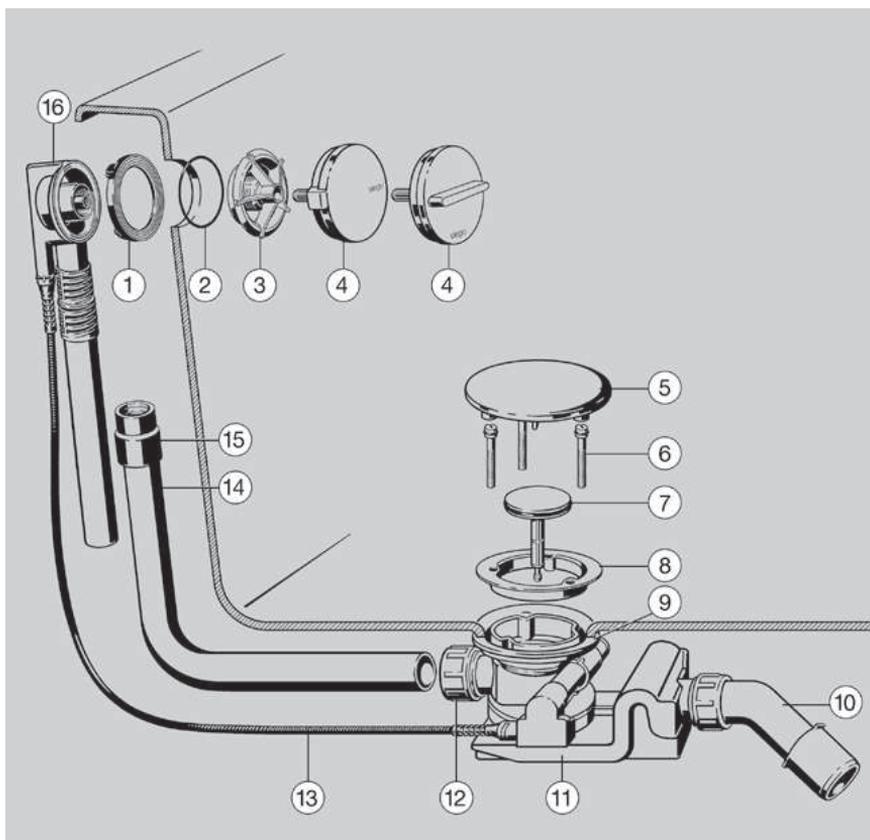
65 Komponenten – Rotaplex Visign R5/R3
